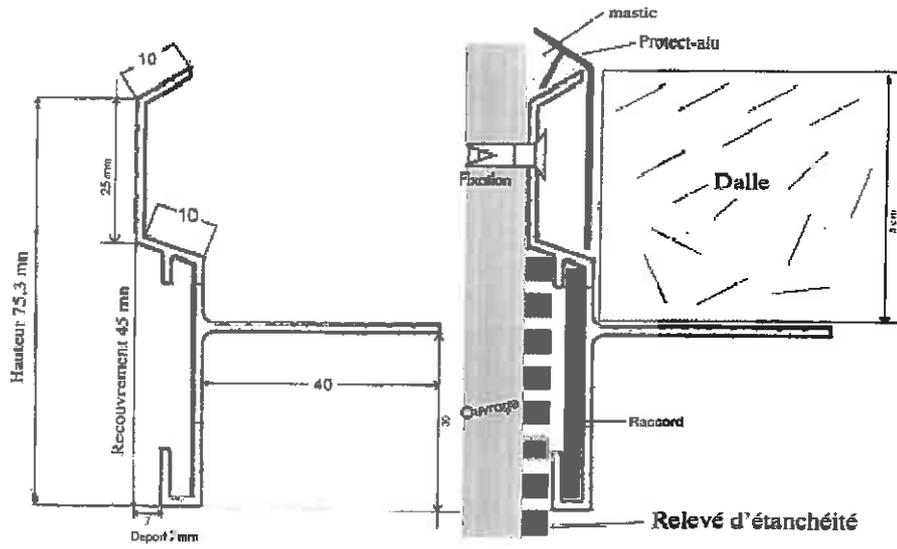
Coupe de principe avec le Solin Porte-dalles Protect Alu sur demande des DPM
